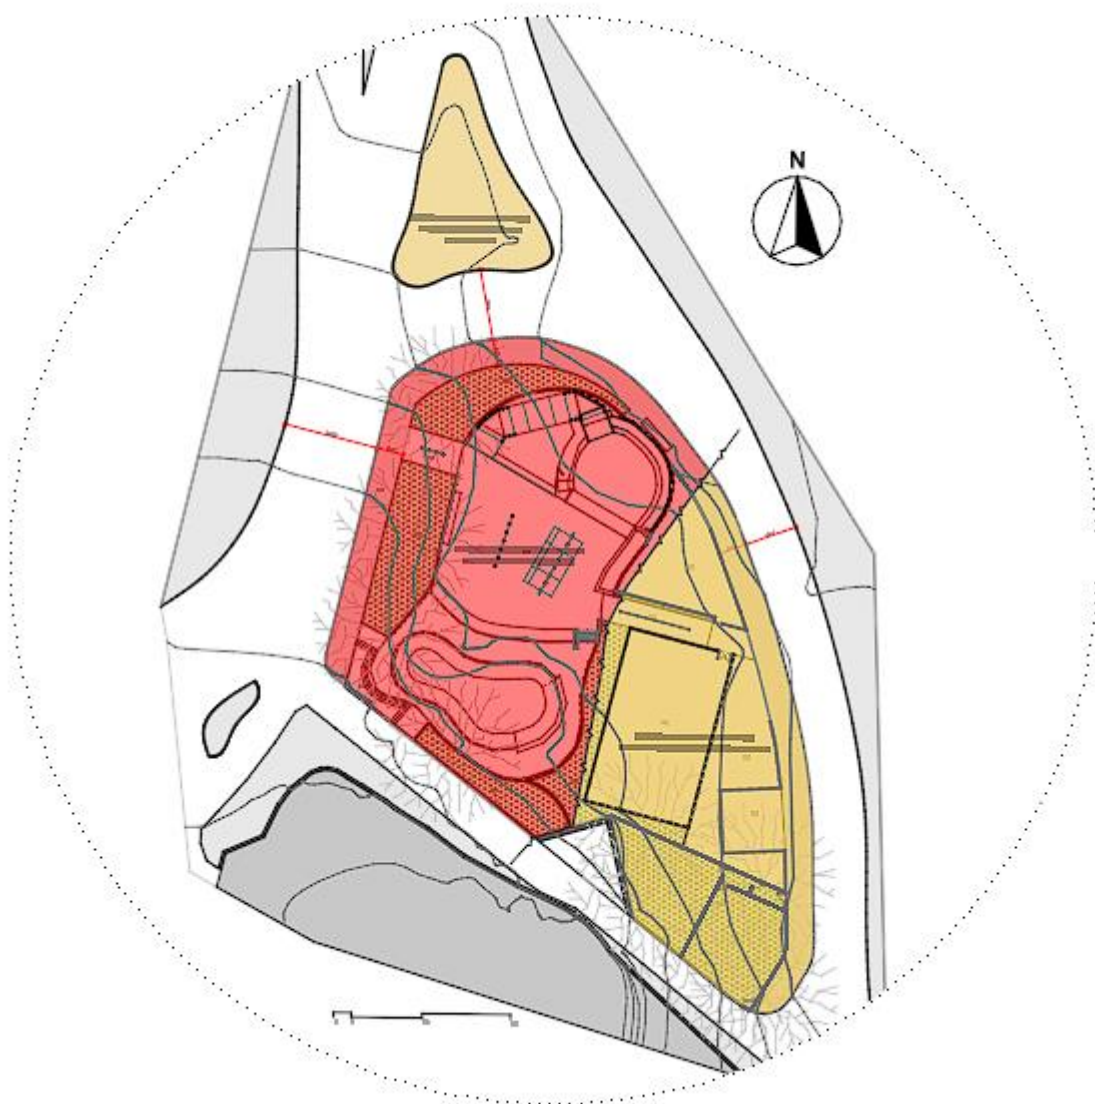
Planta de Situação do projeto Arquitetônico feita pelo Archicad
